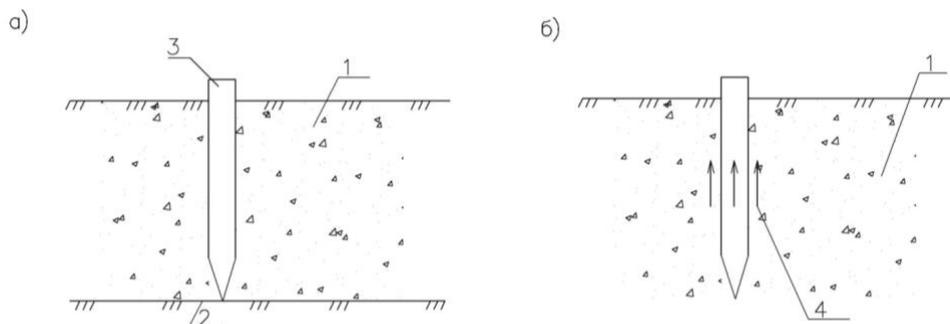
Схемы передачи нагрузки сваями на основание:
